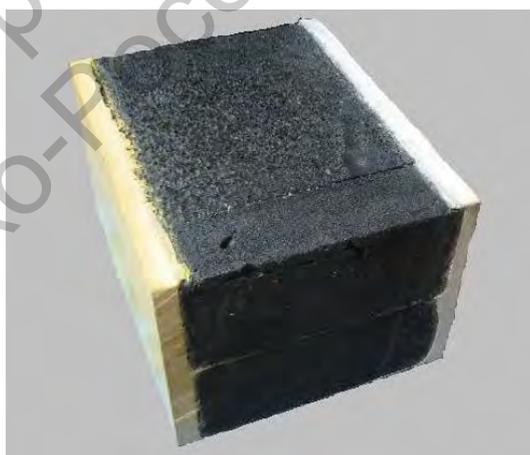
Общий вид блока стенового трехслойного с гибкими связями
